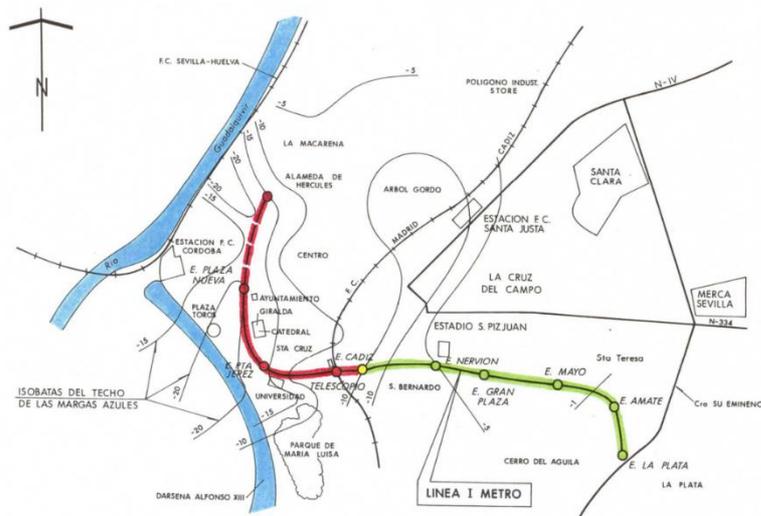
Sector proyectado de La Plata – Alameda de la línea 1
